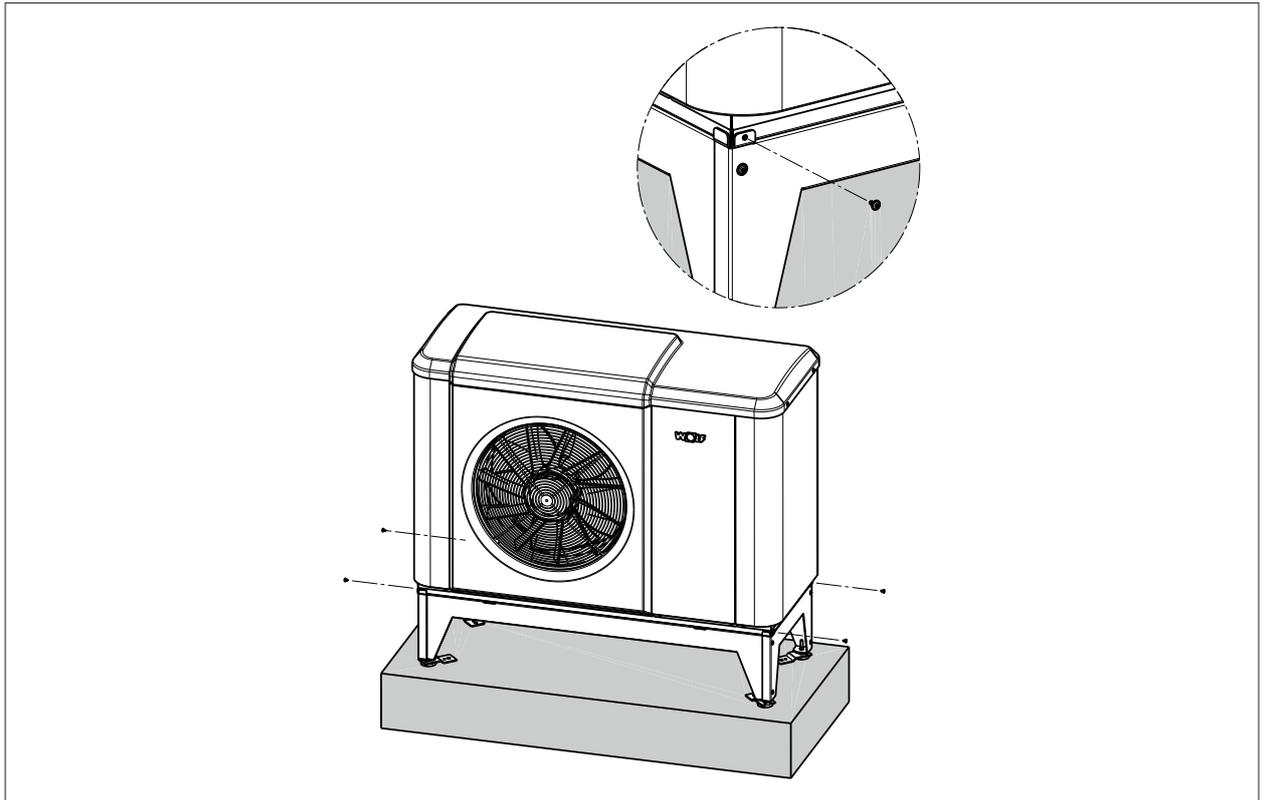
Avvitare l'unità esterna sul rialzo a pavimento
